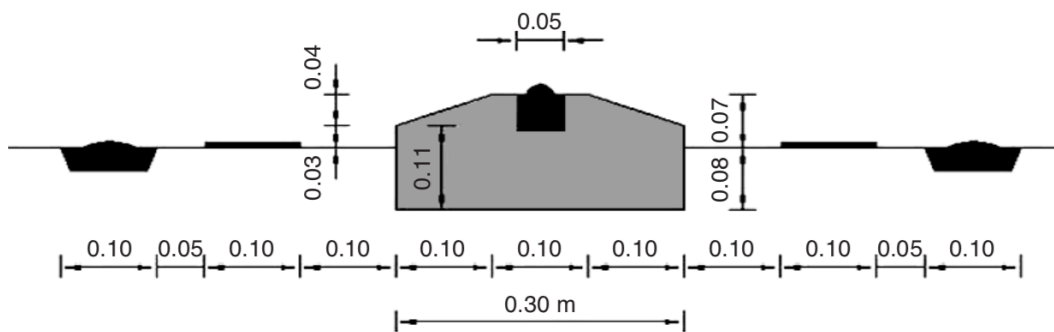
Sección transversal de divisor de carril montable elevado (Fortuijn, 2009)
